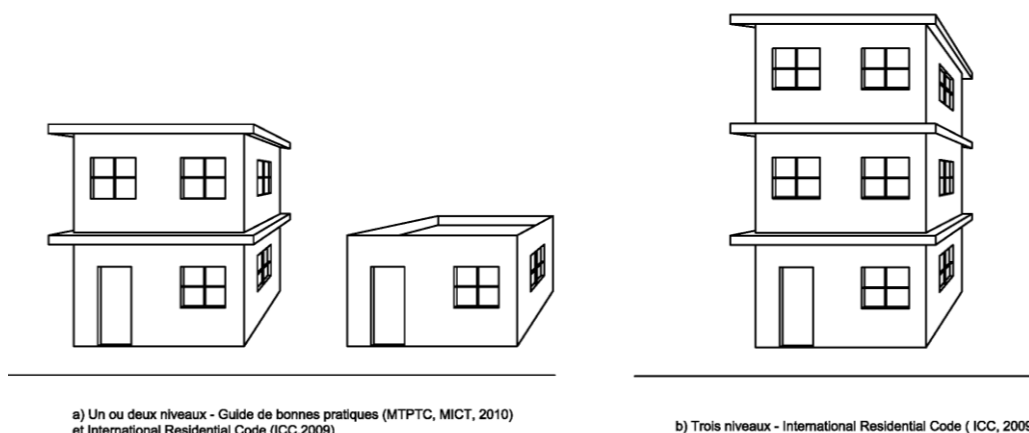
Exemples de bâtiment conventionnels
